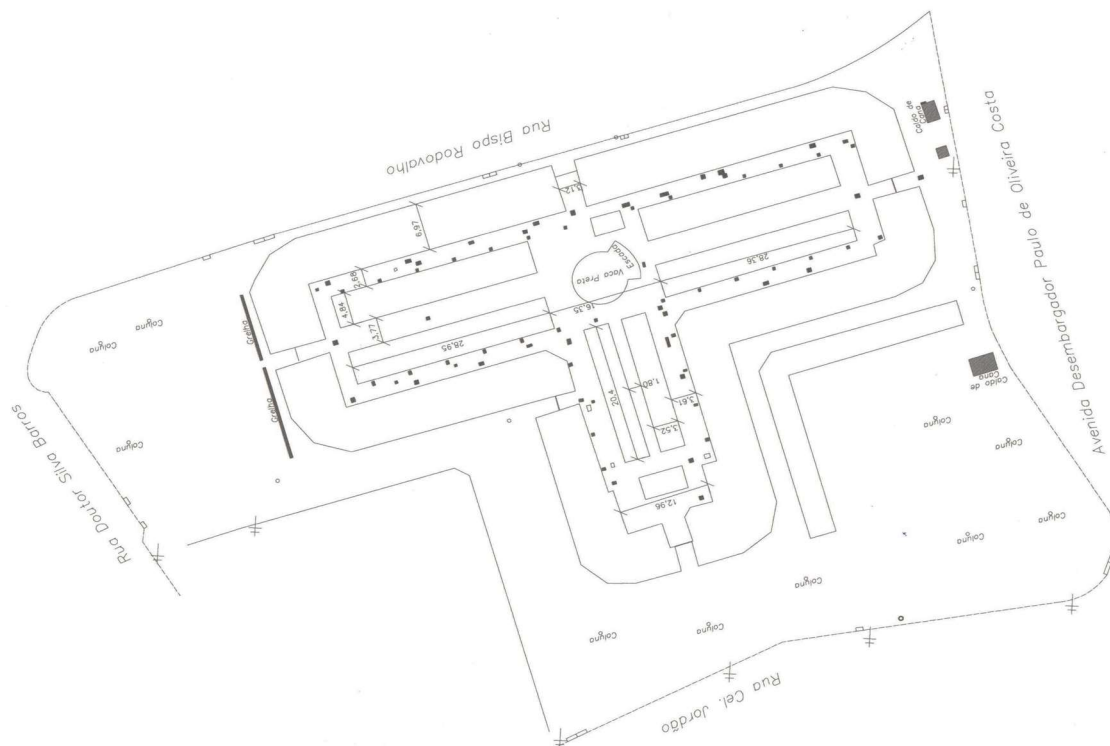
Planta de dimensionamento do mercado de Taubaté
